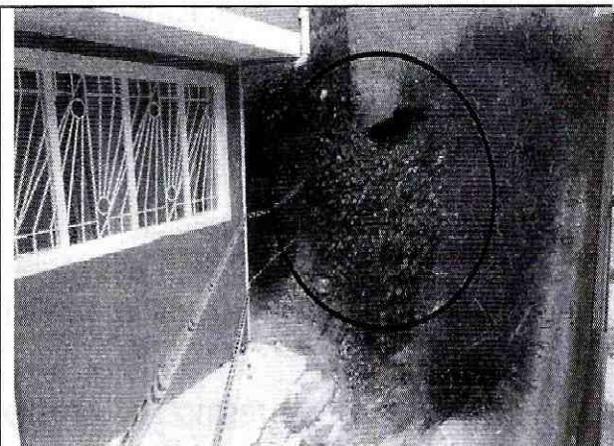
Vista de la fachada de la vivienda de la Transversal 13C Bis No. 46-94 Sur, contigua a escaleras peatonales en concreto
